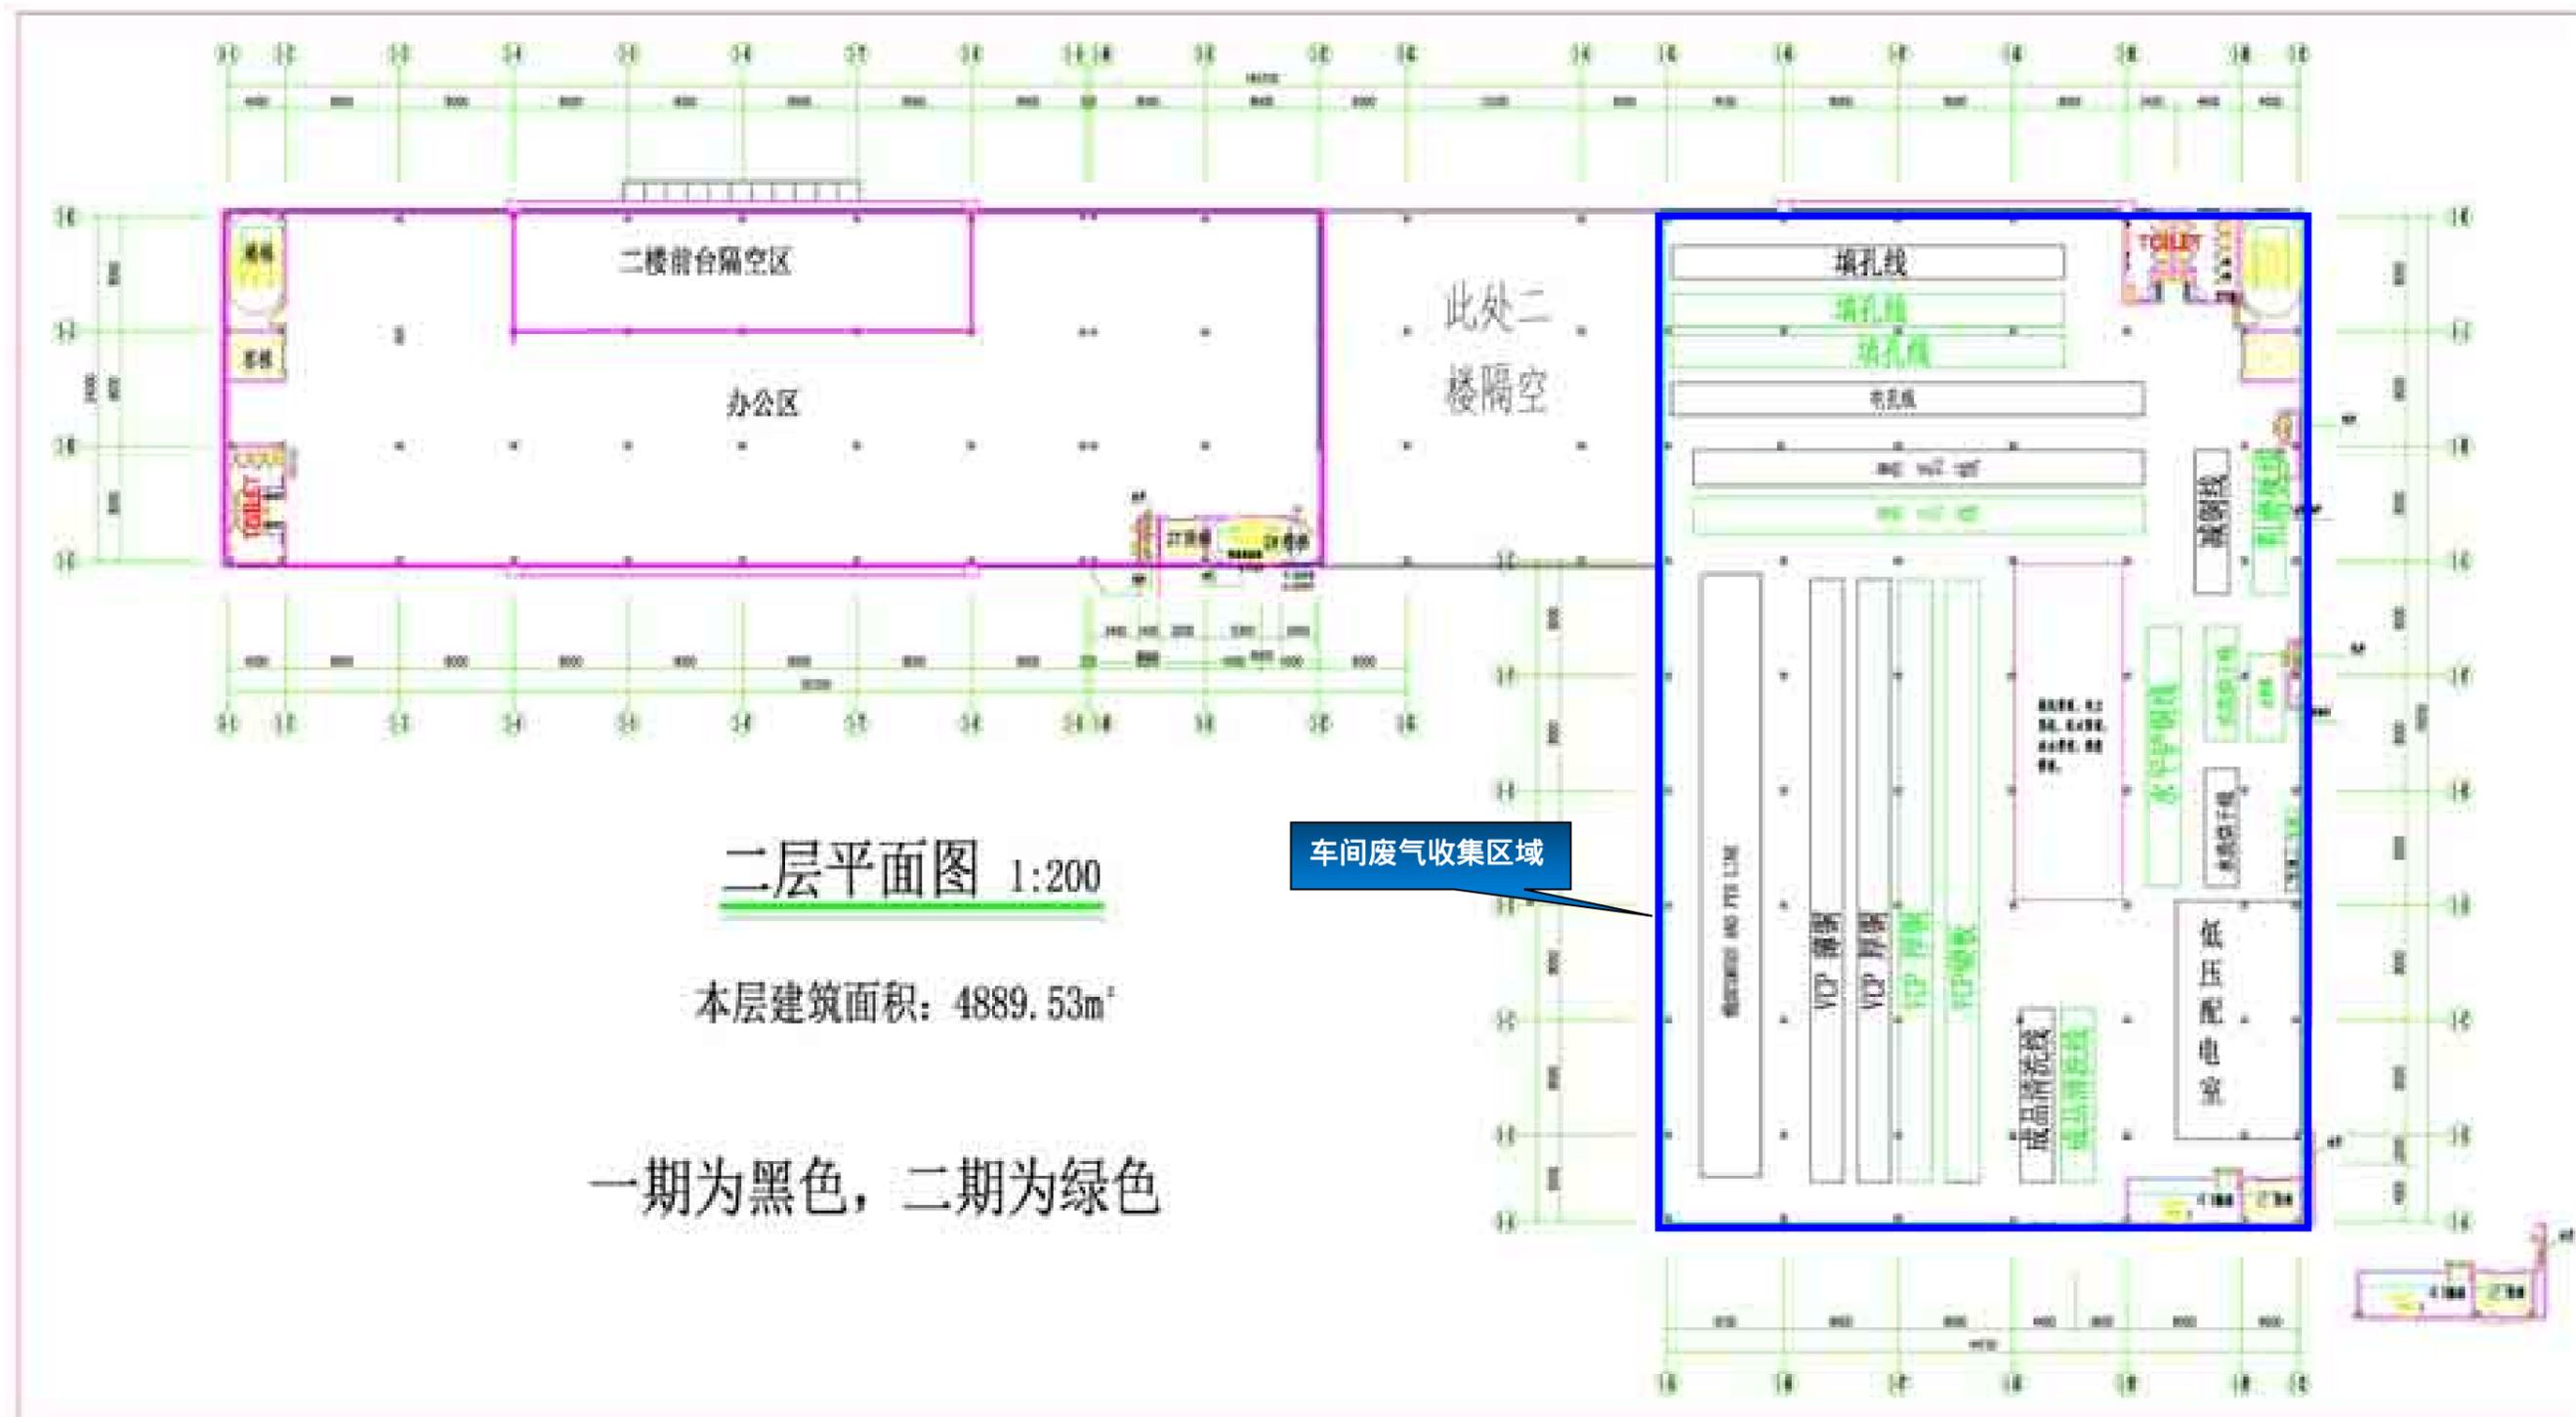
(b) 本项目 1# 厂房平面布置图 (二层)
